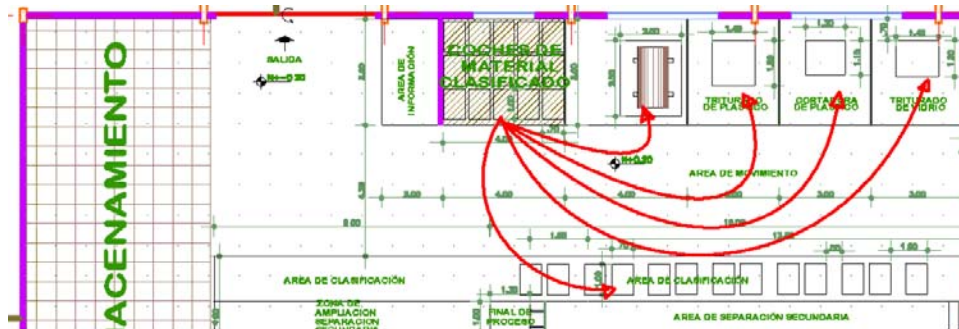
Vista arquitectónica y distribución de coches de material clasificado para áreas de clasificación, triturado, lavado y secado
